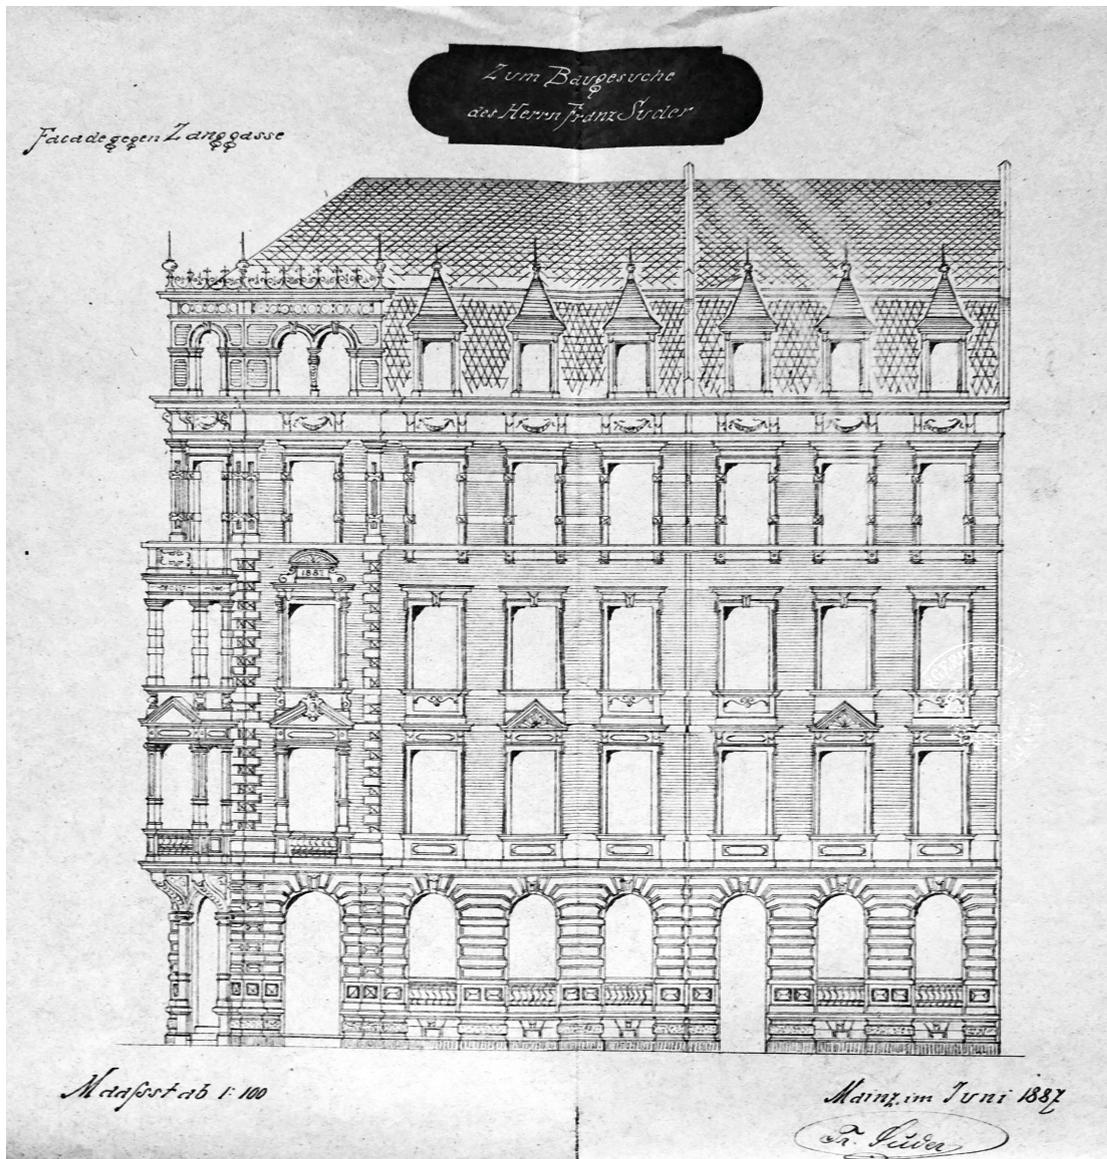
Baugesuch, Kaiserstraße 16, Neubau Franz Suder, 1887
